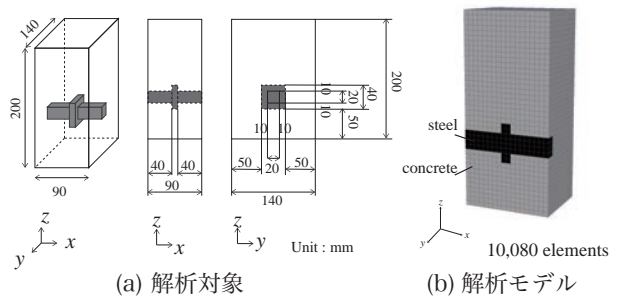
柱のひび割れ問題のモデルと力学的境界条件
